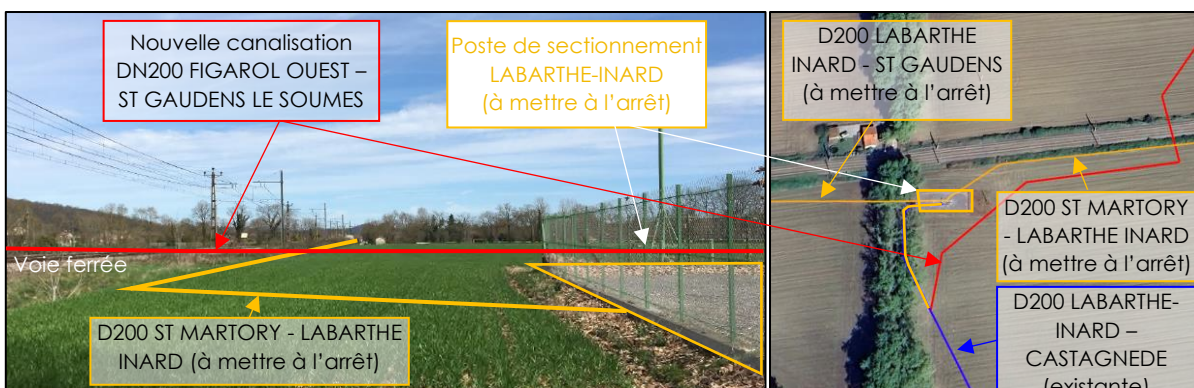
Traversée de la voie ferrée à Labarthe-Inard et poste de sectionnement de Labarthe-Inard
